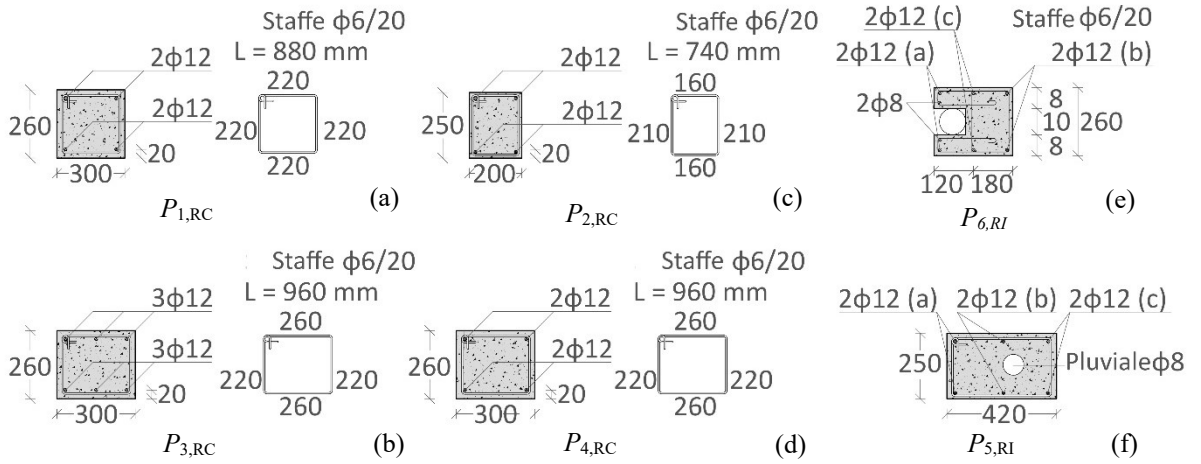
Sezioni dei pilastri a sezione costante appartenenti al piano terra (a,b,d) e al primo (c,e,f)
